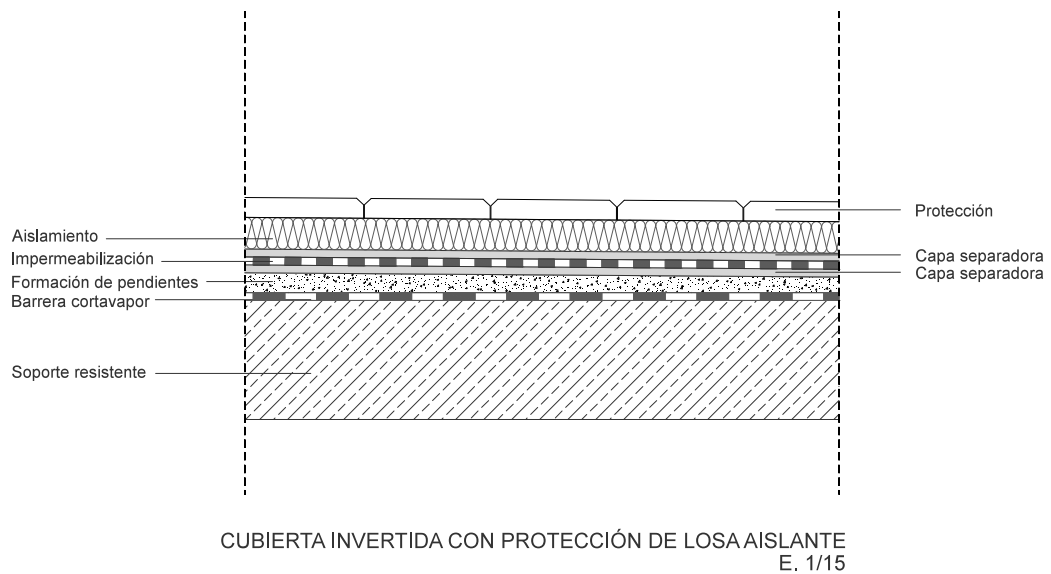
Detalle cubierta invertida con protección de losa aislante
